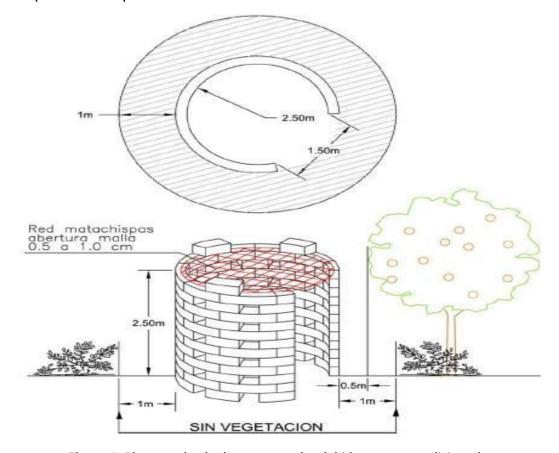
Planta y alzado de un quemador debidamente acondicionado.
